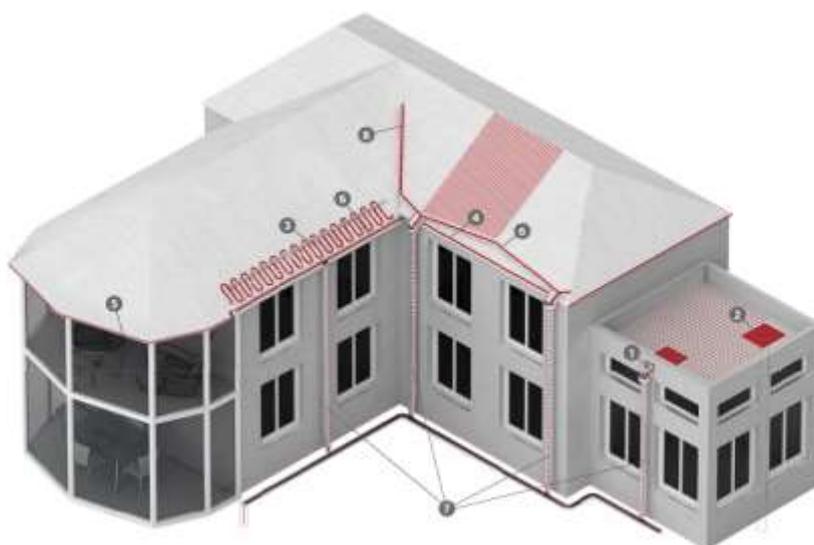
Расположения зон прокладки нагревательных кабелей на примере здания
